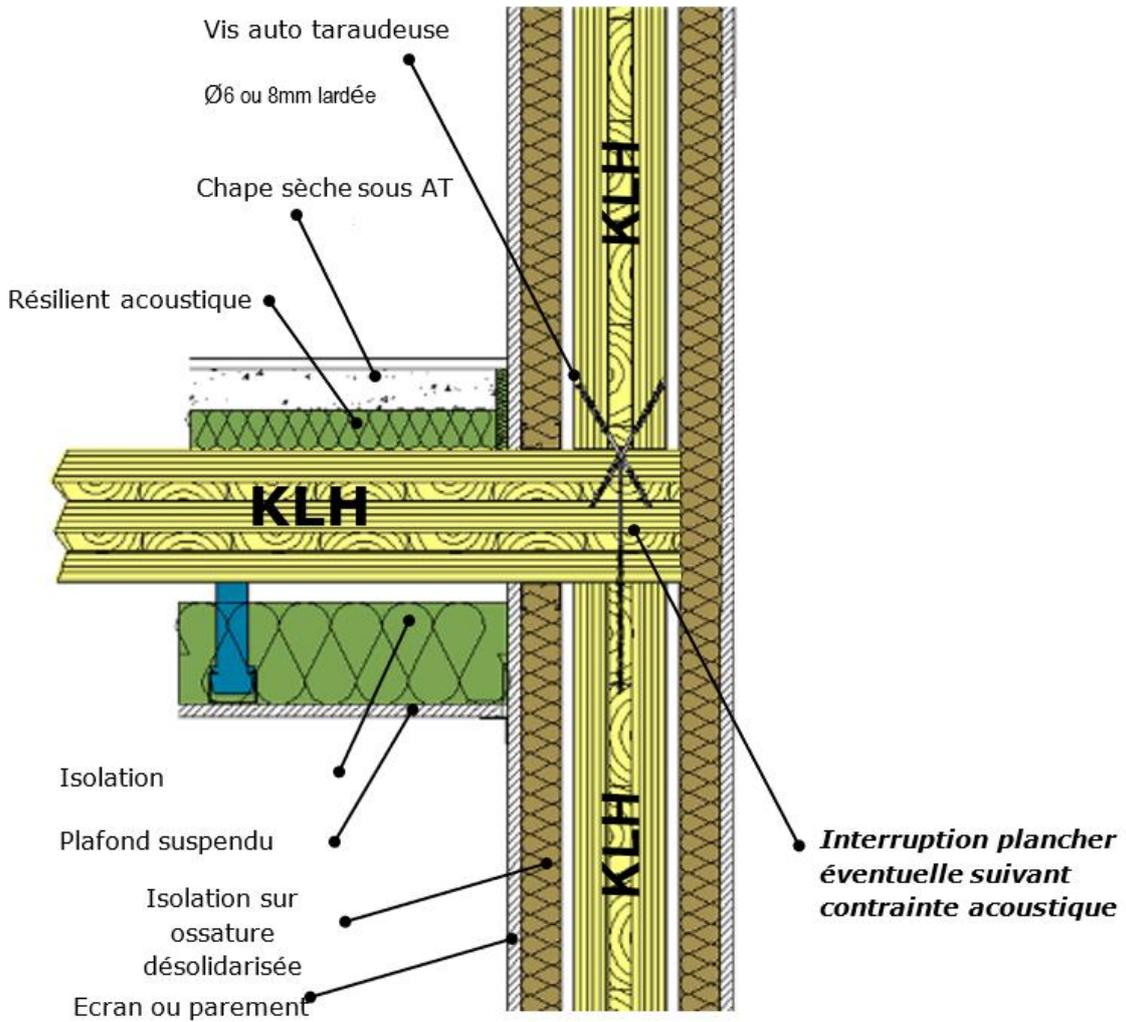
Coupe verticale sur locaux superposés avec plancher filant
